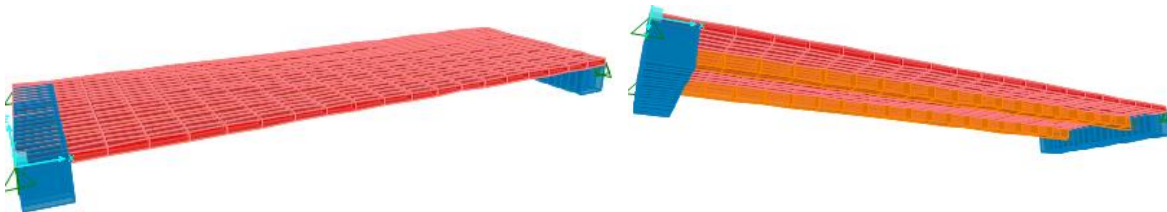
Modelo numérico de losa de vigueta y bovedilla apoyada sobre vigas
